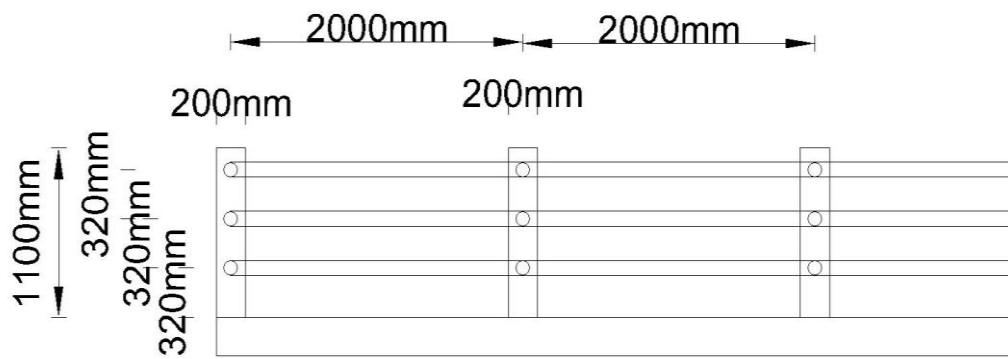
5: Distribución de las barandas y protecciones laterales de puente (Fuente: Elaboración Propia)
